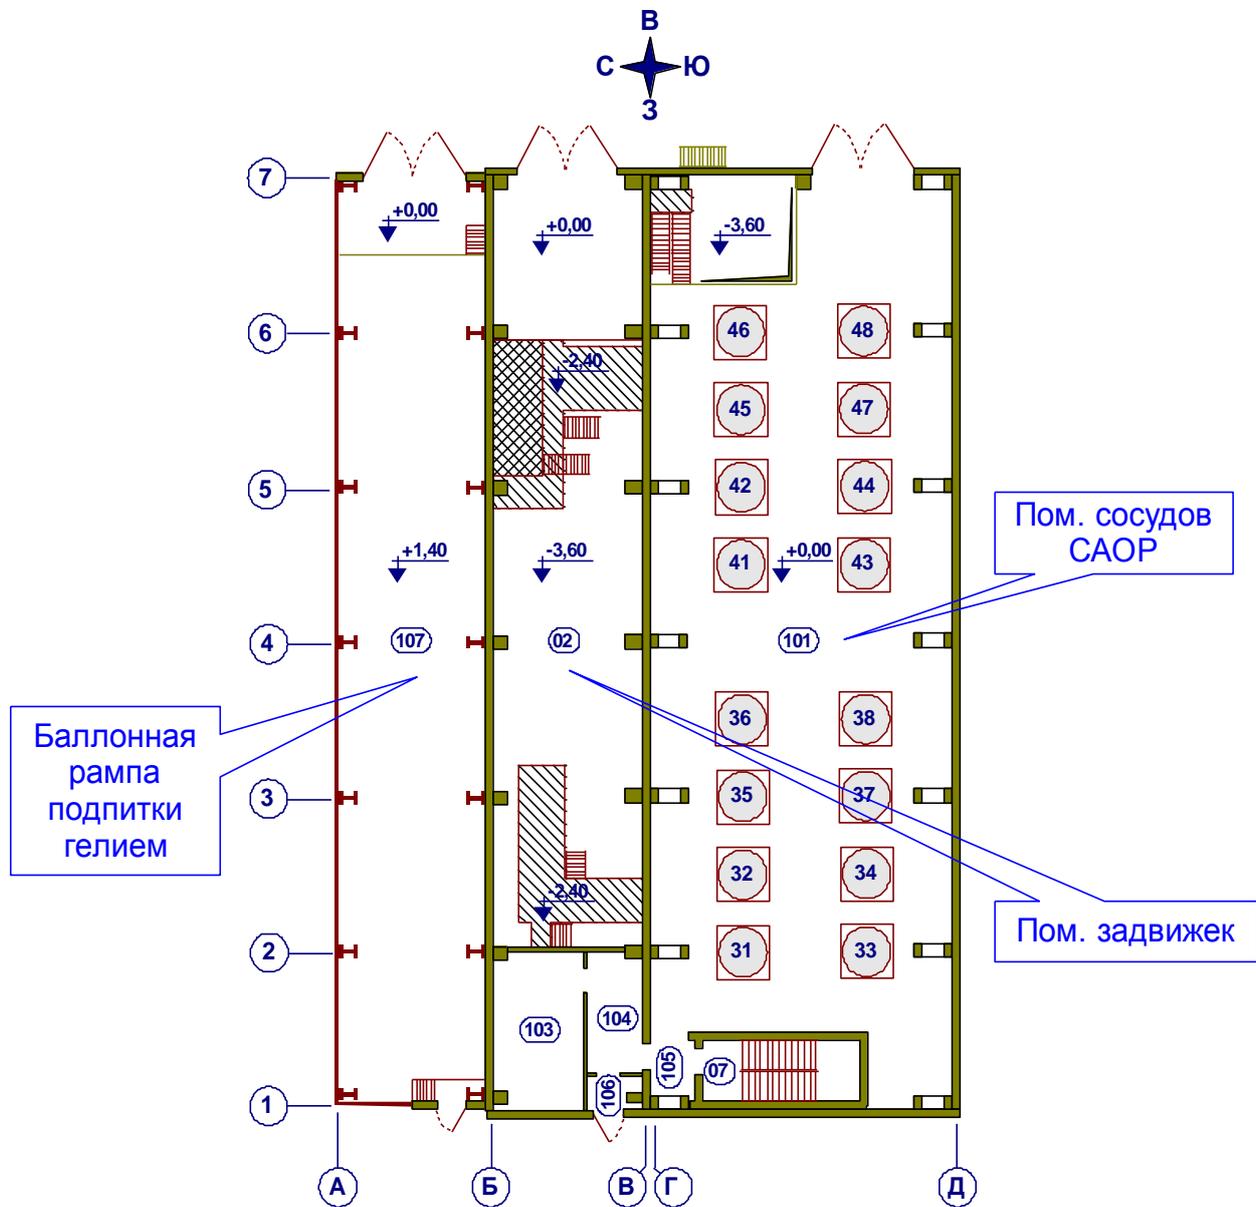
План здания 117/1 на отметке +0,00 м
